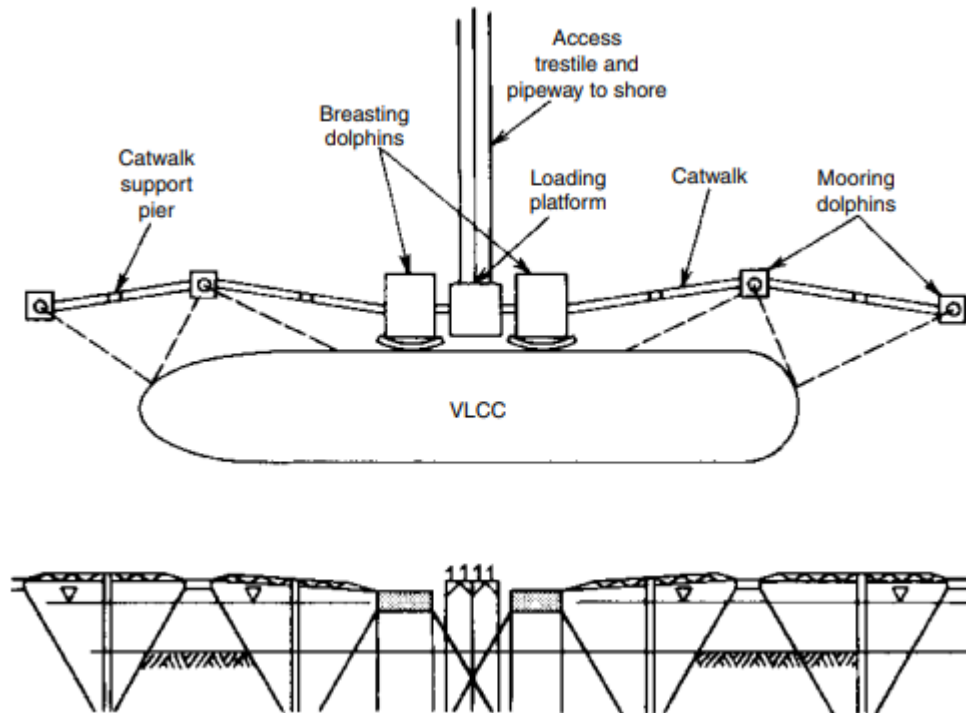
Tipos de estacas tipicamente utilizadas na construção de *dolphins
